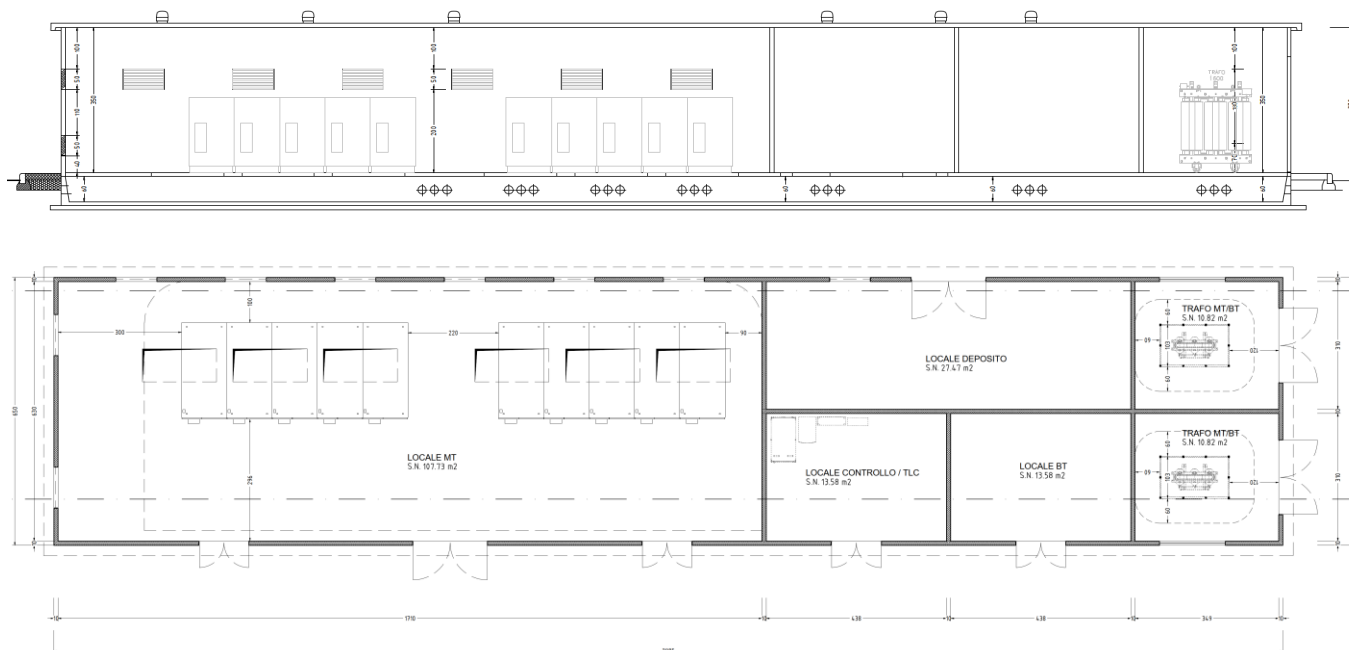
Cabina di ricevimento (CR), vista in sezione e in pianta
